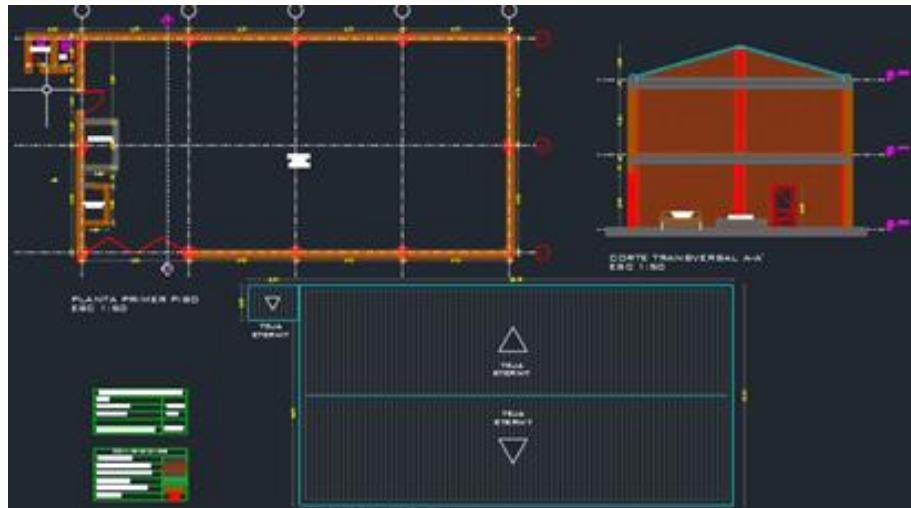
Ejemplo de plano arquitectónico (Plano arquitectónico centro de salud La Rioja).
